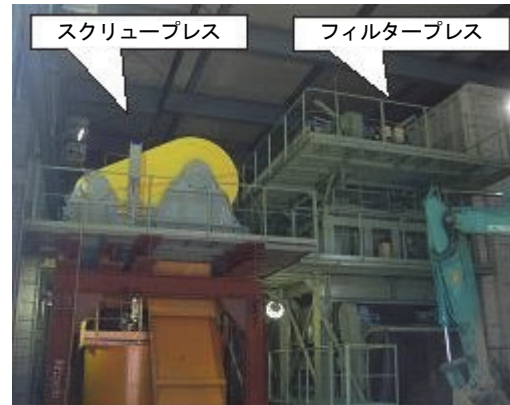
脱水機（スクリーンプレスとフィルタープレス）の配置
